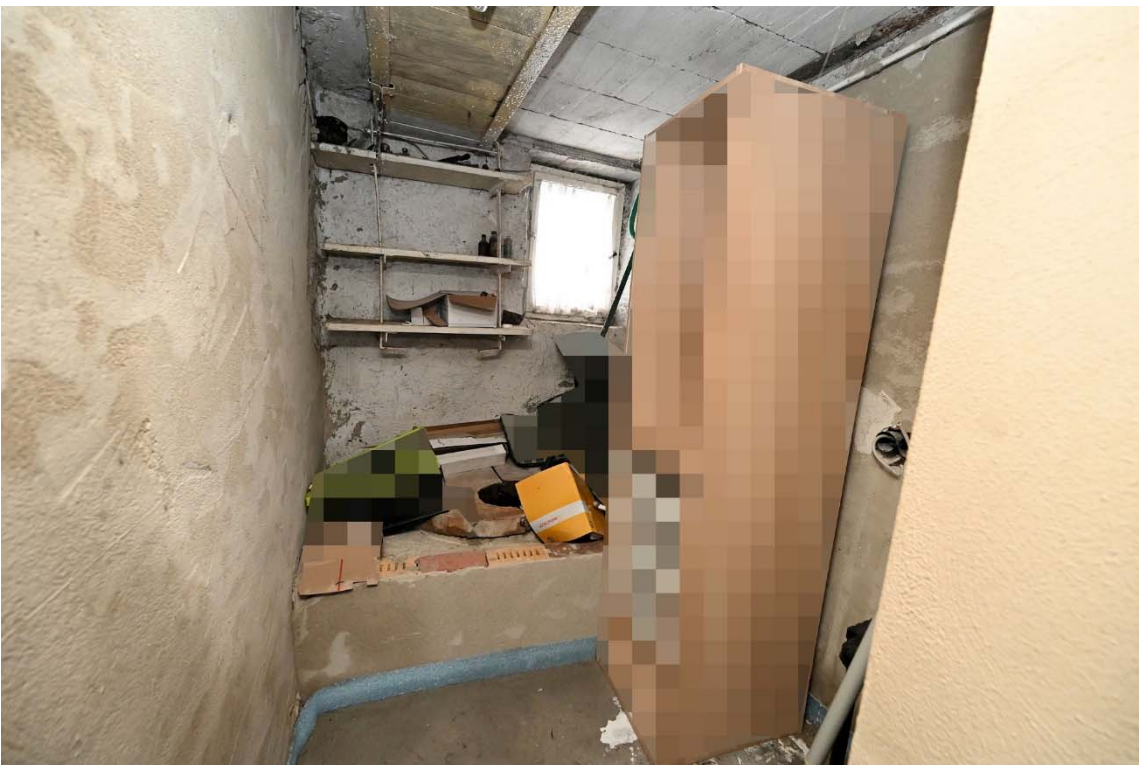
Wohnhaus (A), Erdgeschoss, "Raum mit Brunnen"
